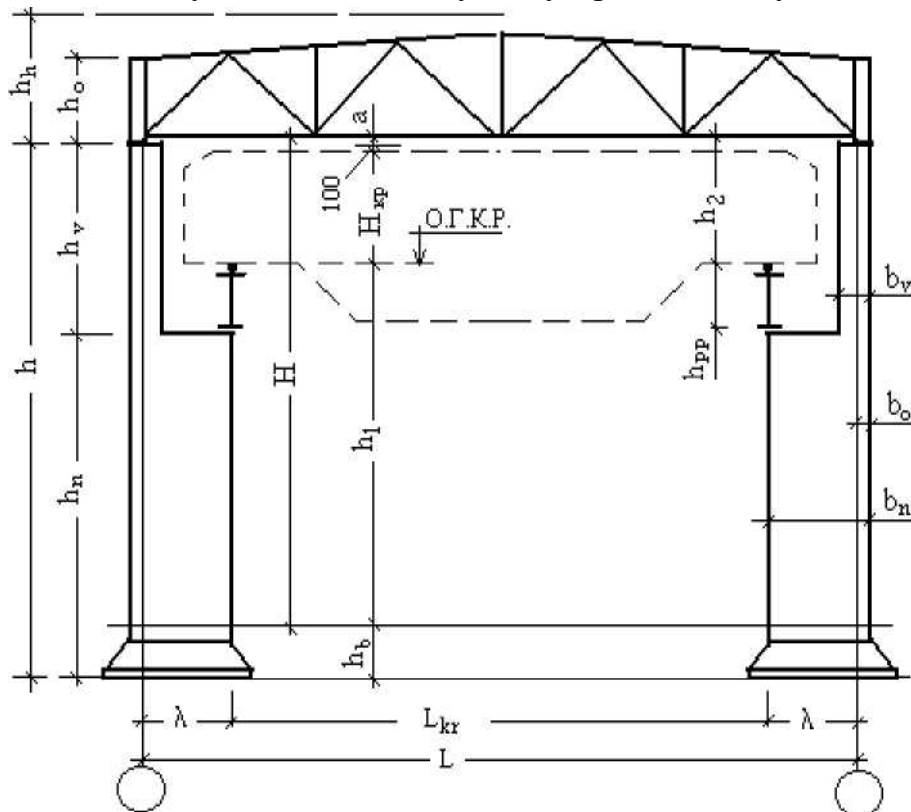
Конструктивна схема промислової будівлі, обладнаної мостовими кранами легкого й середнього режимів роботи
